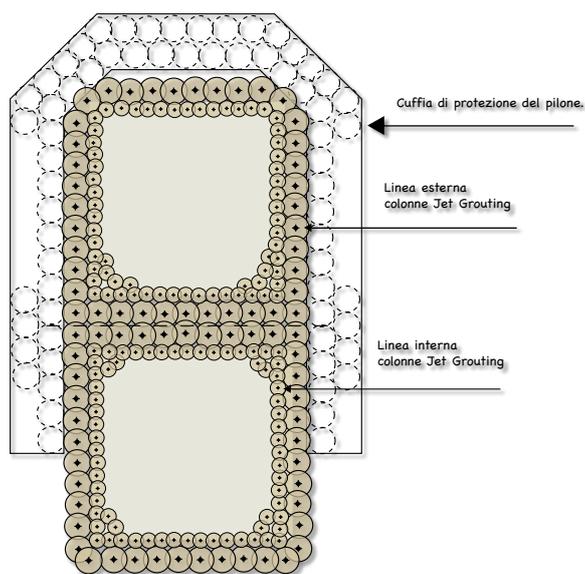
Schema del posizionamento delle colonne Jet Grouting per la realizzazione delle fondazioni a pozzo.
